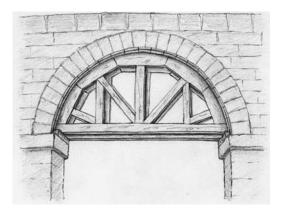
Hipotética disposición constructiva de cimbra de madera sobre impostas para la colocación de dovelas y formación del arco en fábrica de sillares de piedra. (Elaboración propia)
